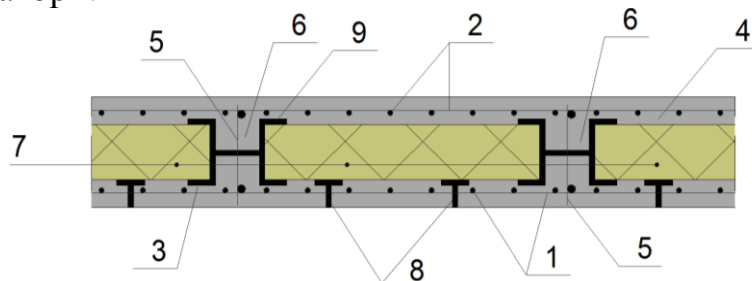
Залізобетонне перекриття полегшеного типу: 1 і 2 - арматура нижньої і верхньої сітки; 3 і 4 - нижня і верхня обшивка; 5 - арматурні каркаси; 6 - ребра перекриття; 7 - вкладиші; 8 і 9 – фіксатори
